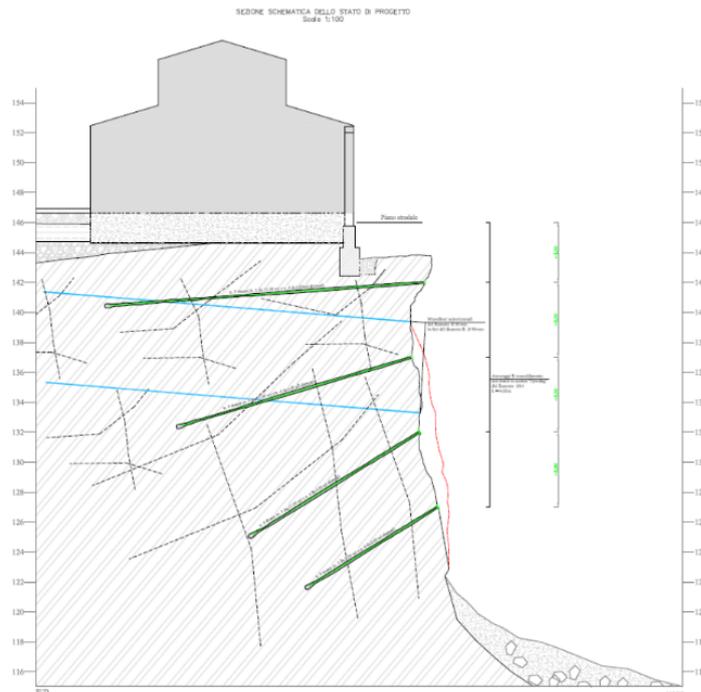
Sezione schematica di intervento con ancoraggi, reti in aderenza e drenaggi sub-orizzontali.
